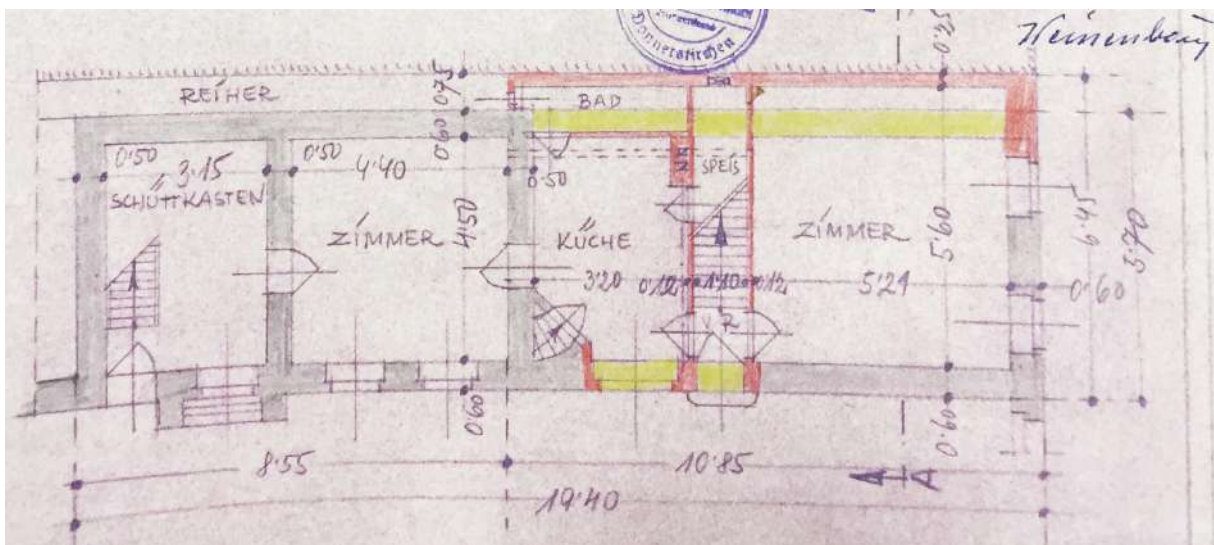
Grundriss Erdgeschoss, 1955
